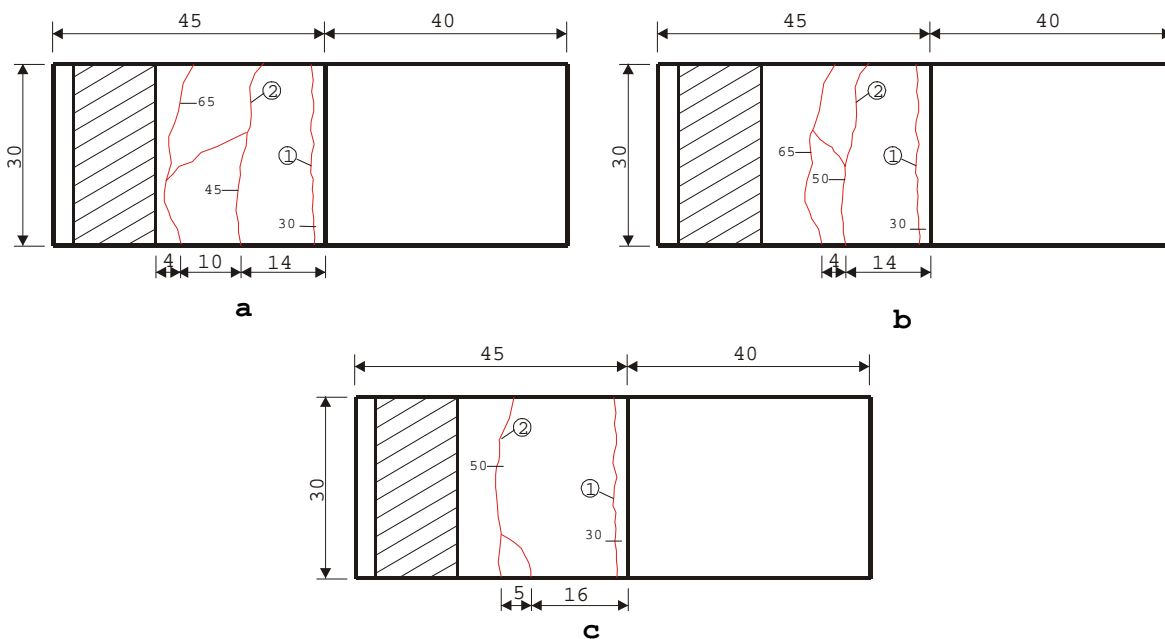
Releveu fisuri pe fața orizontală a consolelor
